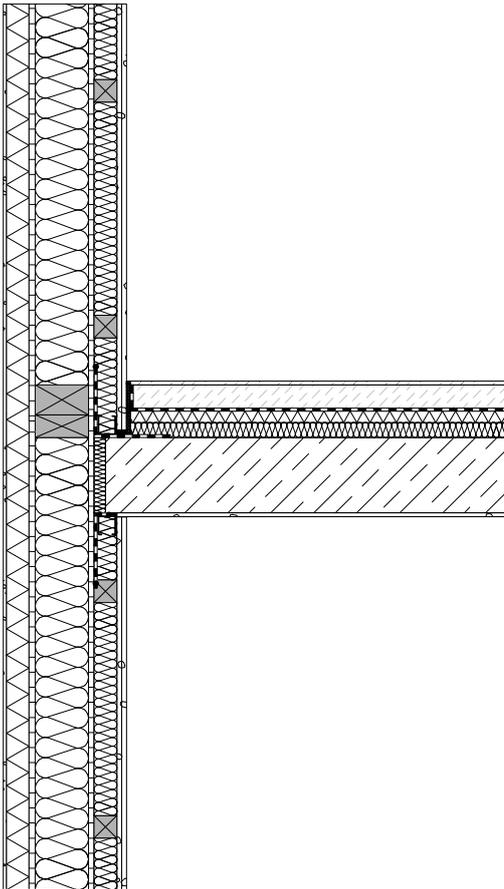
Anschluss Außenwand WA1-3 - Geschossdecke DE1
